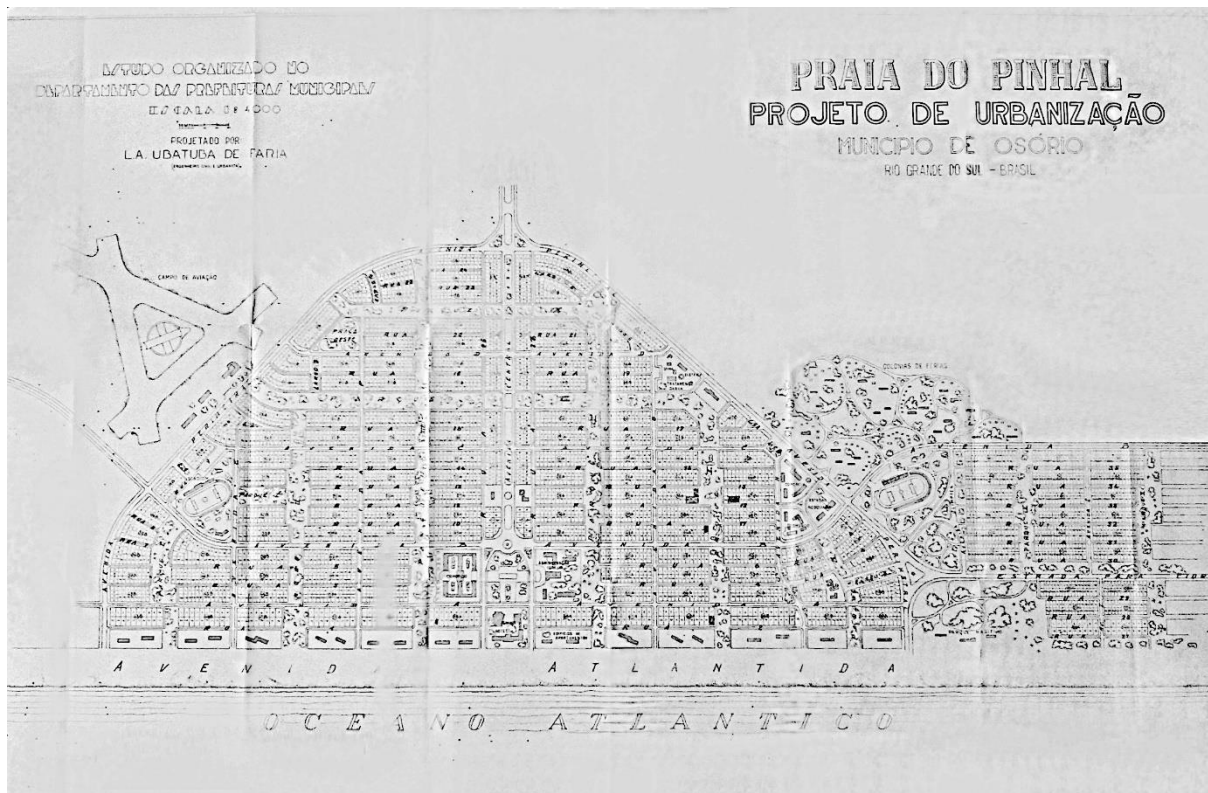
Planta do Projeto da Praia do Pinhal, 1950.
